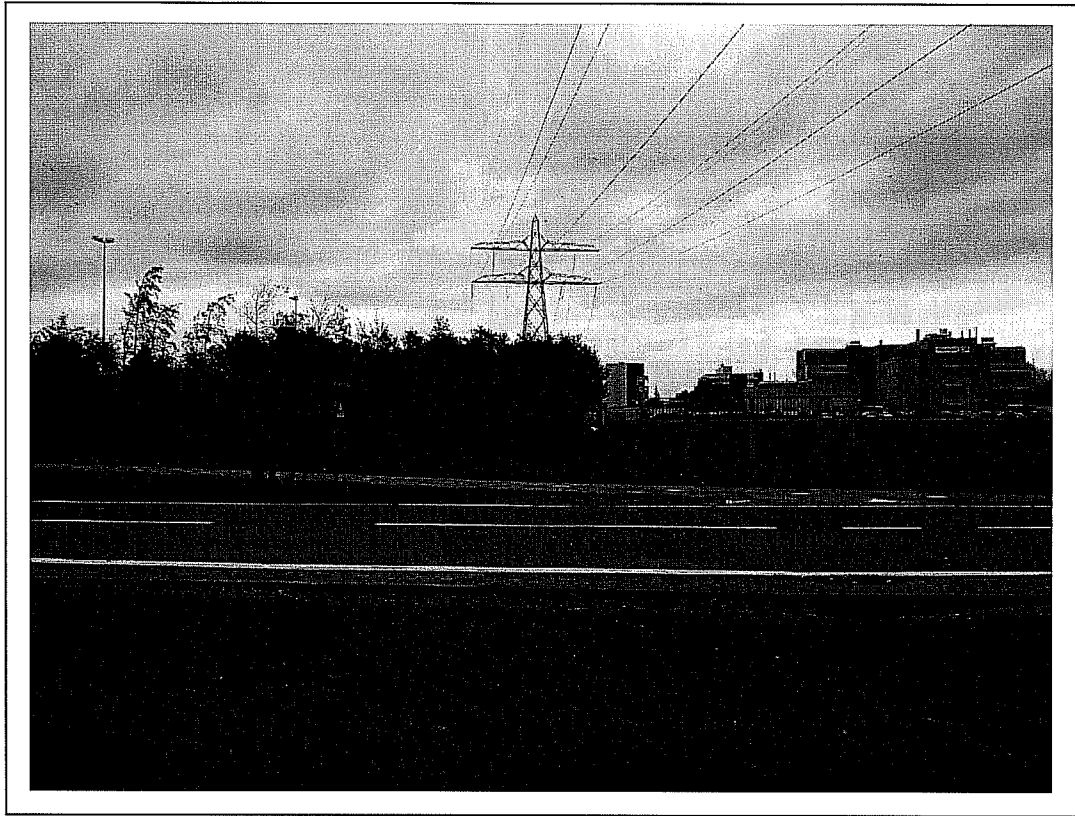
Geplande locatie van de enkelstrooksrotonde met te verwijderen opslag van eik
